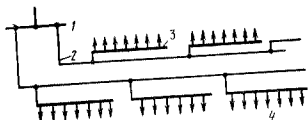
Магистральная схема сети, выполненная шинопроводами:
